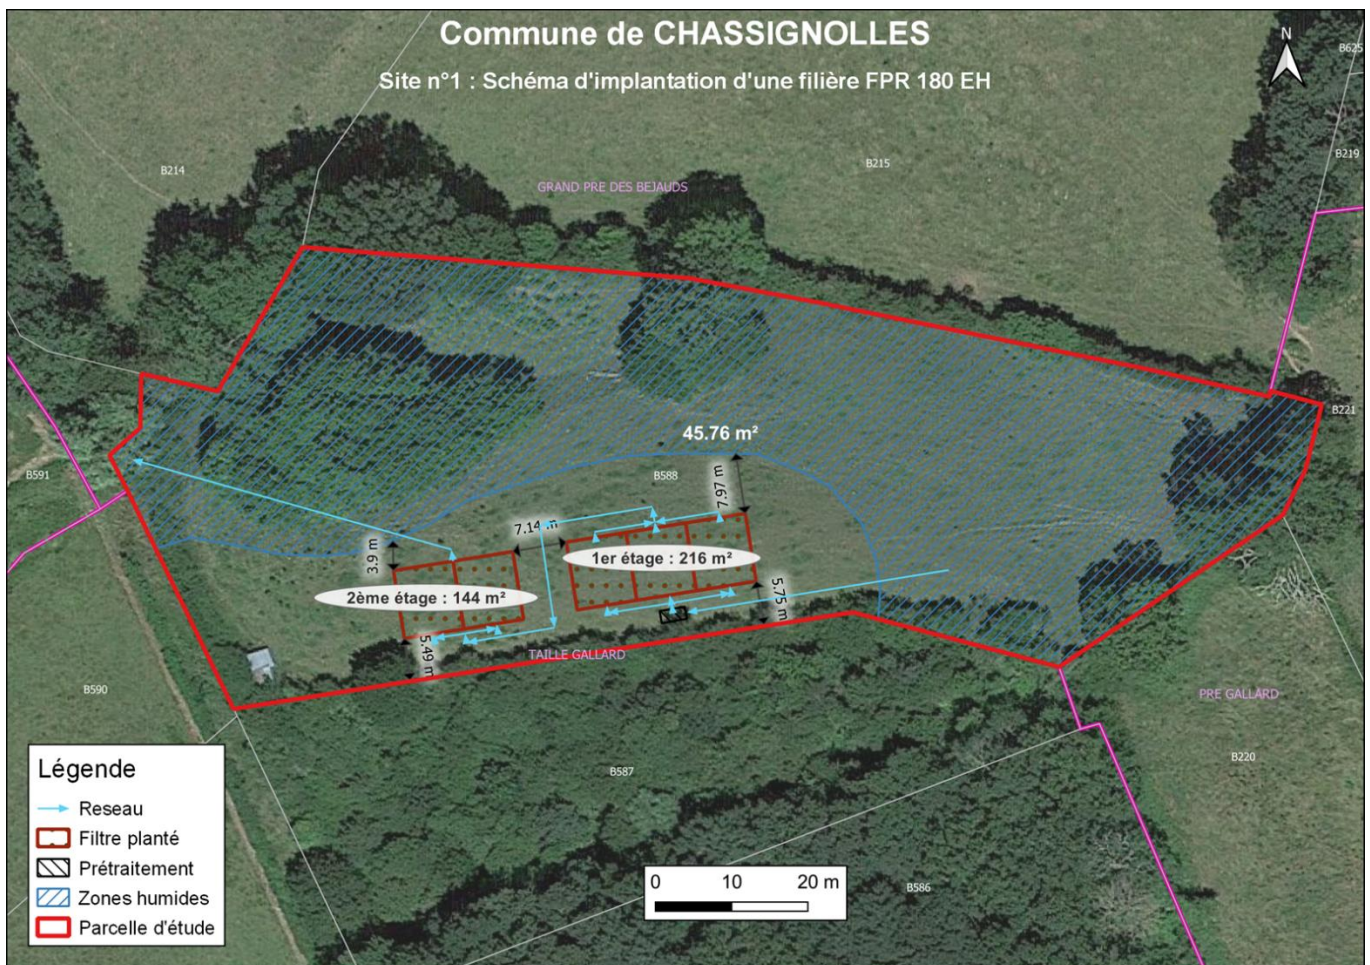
Implantation possible d'une filière FPR 180 EH sur le site n°1
